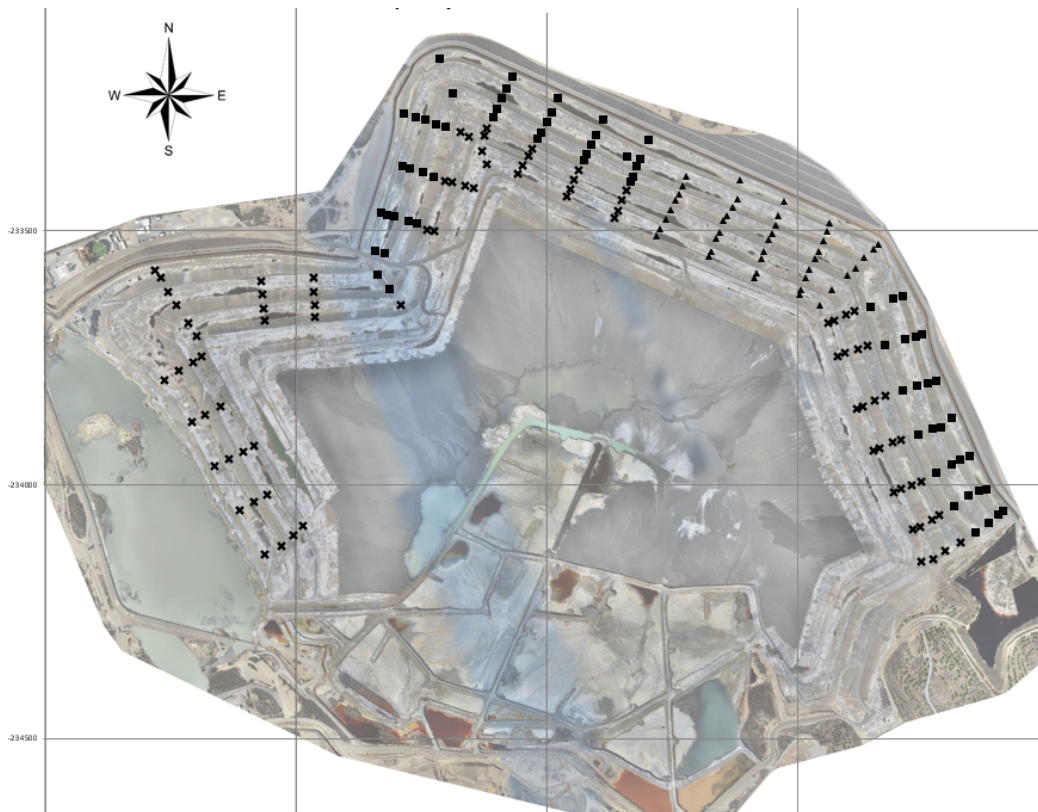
Distribuição espacial em planta dos INA construídos até setembro 2022
